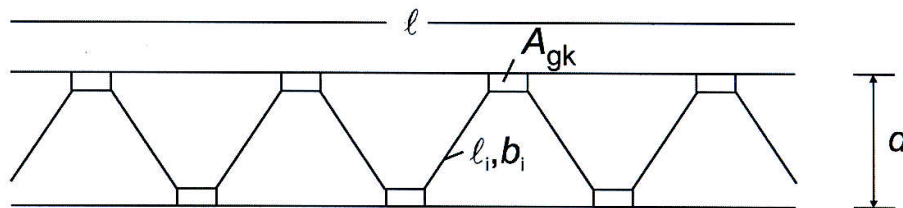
Schema di trave reticolare piana di forma rettangolare.
